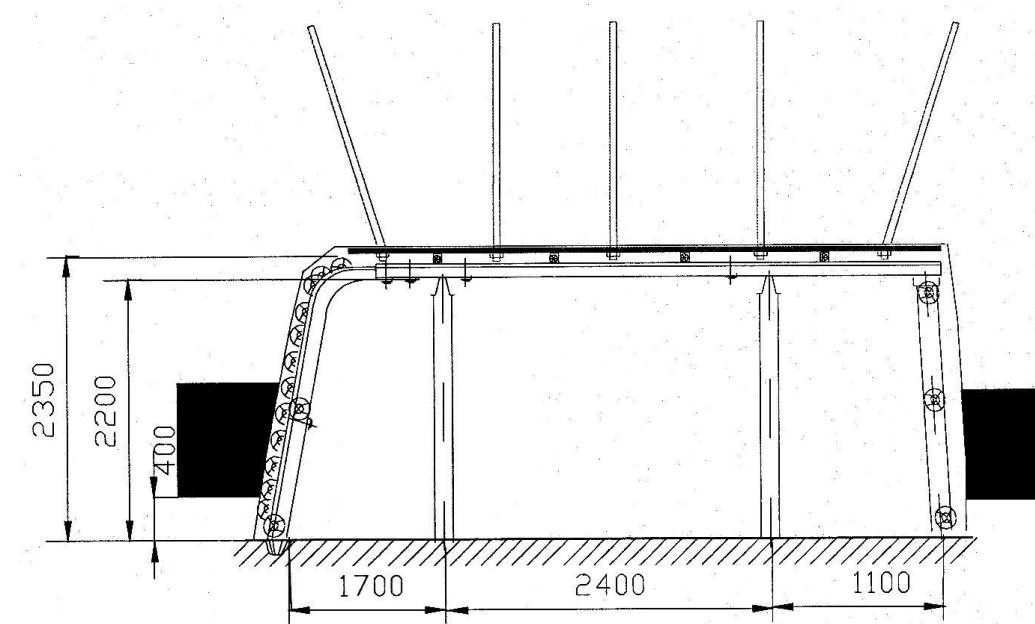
Крепление монтажного ходка с анкерной крепи.
